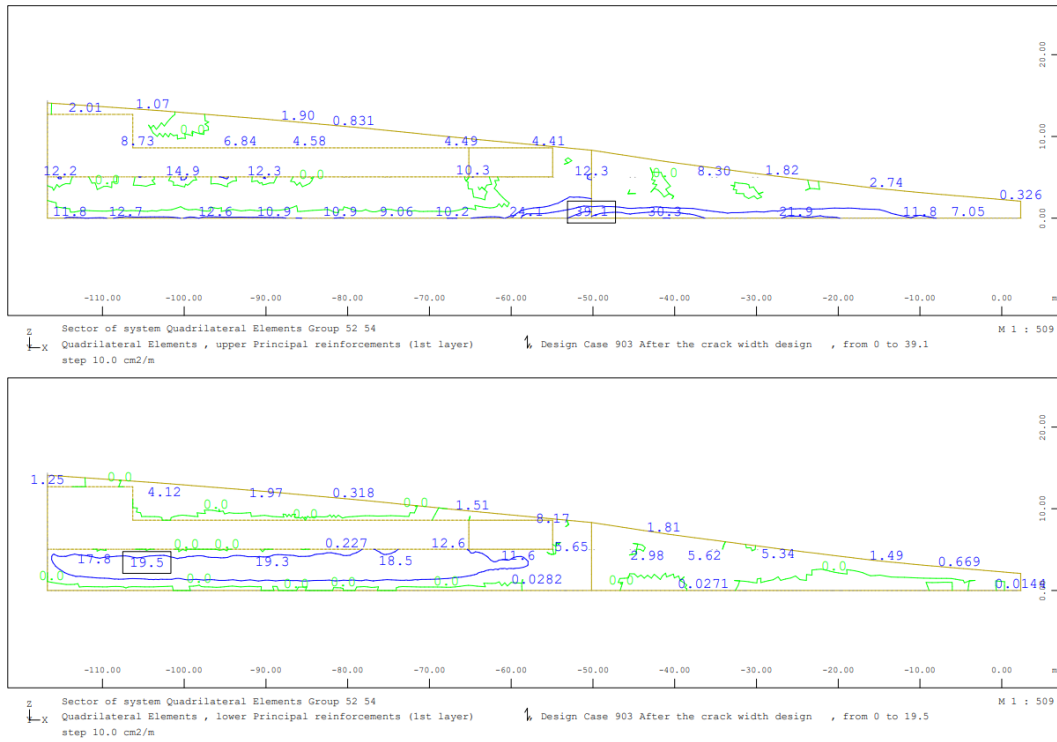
Armadura vertical na face exterior (sup.) e interior (inf.) – fachada Norte da Estação - ELS
